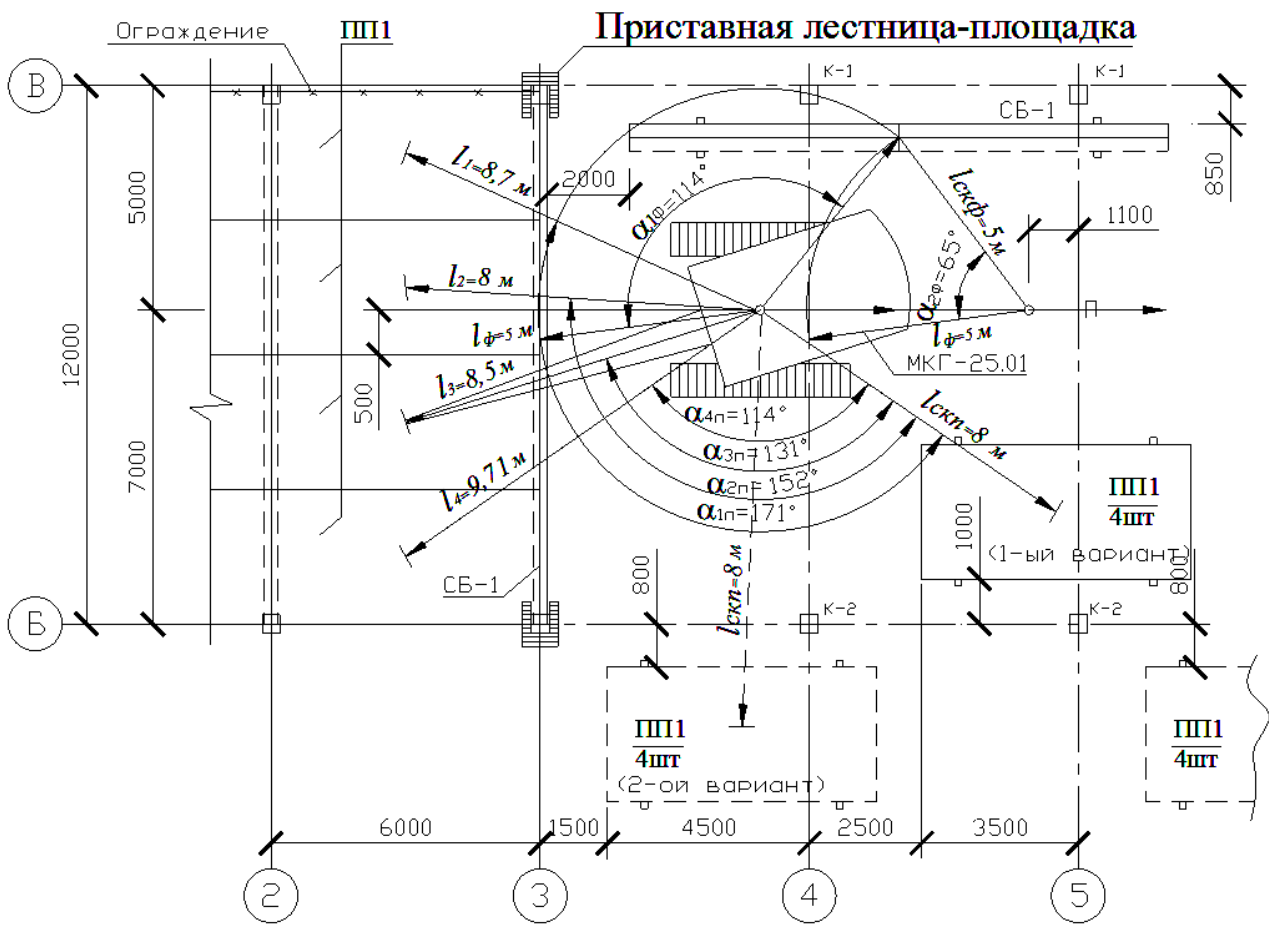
Схема монтажа железобетонных конструкций покрытия при пролете 12 м
